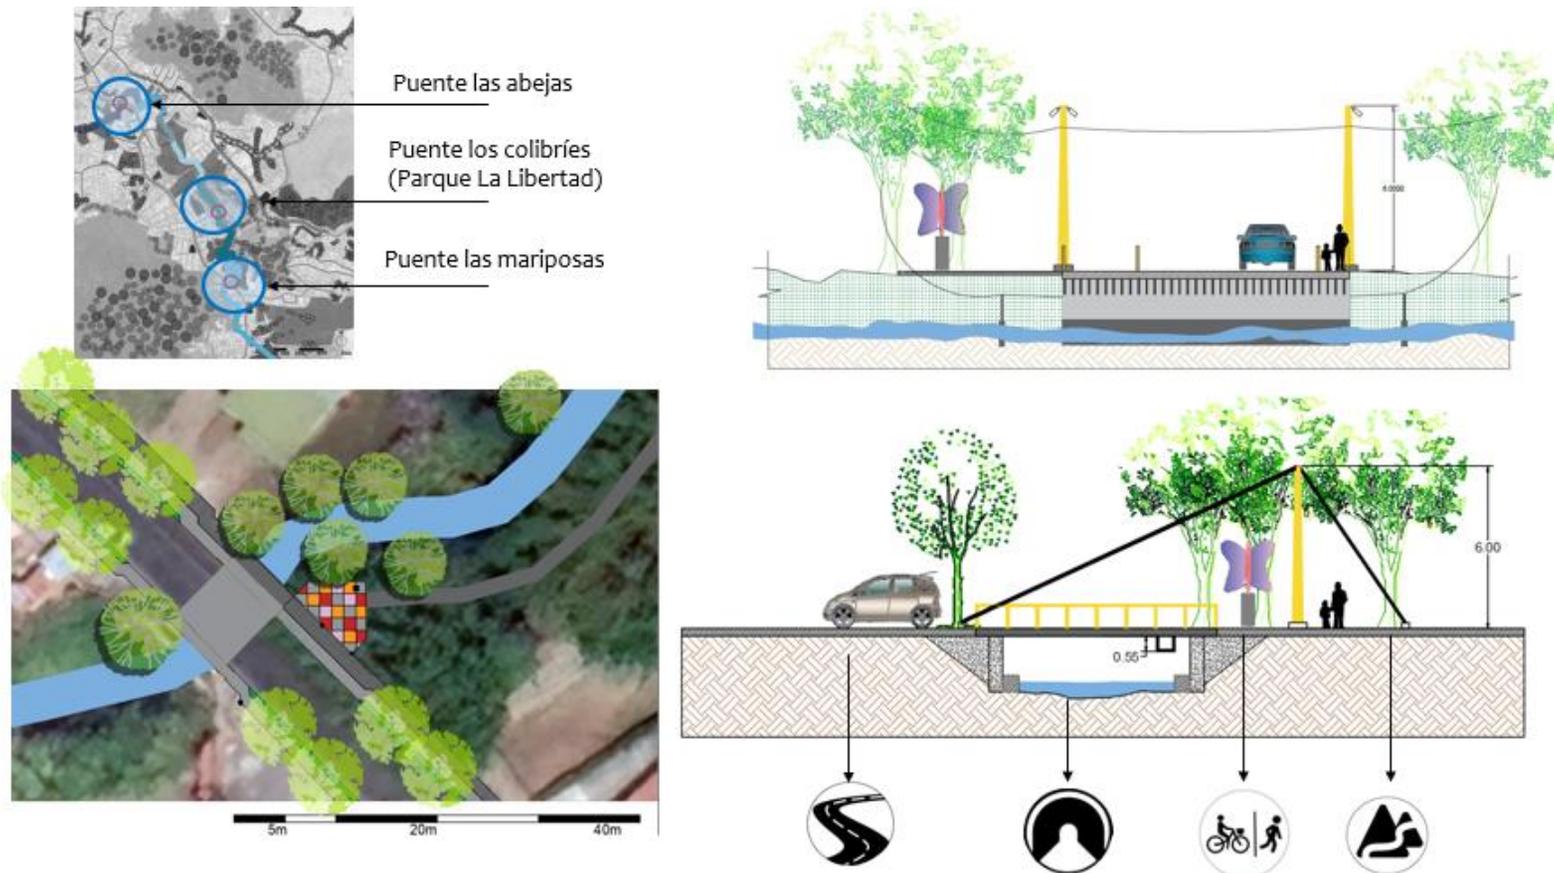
Planta de conjunto con ubicación de ingresos y planta y corte prototipo. Fuente: Elaboración propia.
